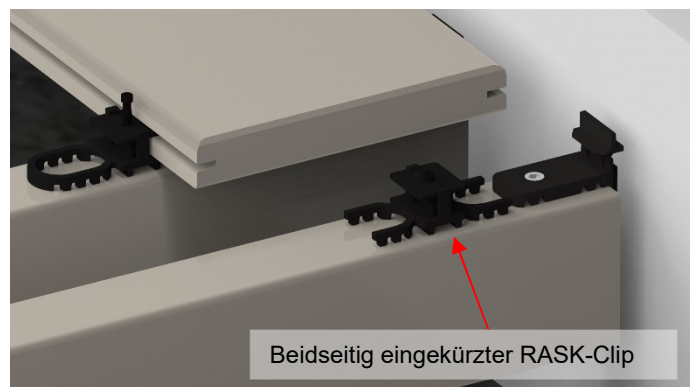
Für die Drainagerinne müssen zusätzlich auf jeder Unterkonstruktion ein beidseitig eingekürzter RASK-Clip montiert werden. Mit einem z.B. Seitenschneider ist das einfach machbar. Der RASK-Clip kann komplett festgeschraubt werden.
